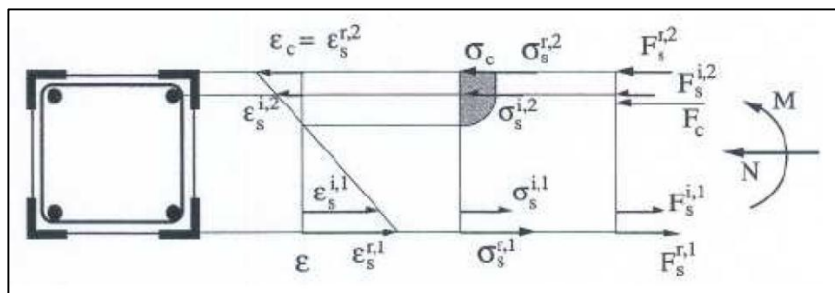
modelo de cálculo de pilares à flexão composta reforçado com cantoneiras metálicas (SOUSA, 2008).
